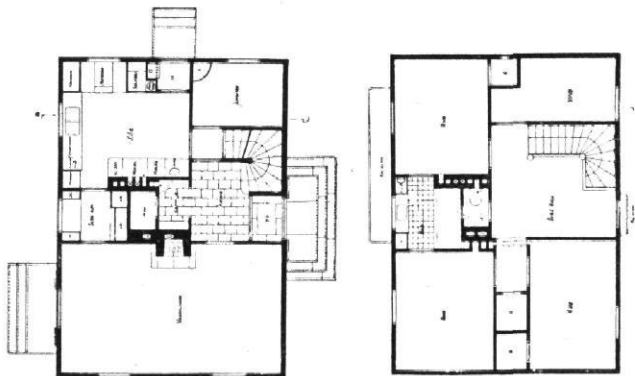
bis 22 | Einfamilienhaus auf der Lidingö-Ausstellung 1926 (vgl. Abb. 16) | Oben und rechts zwei Hauptansichten, links Aufrisse und Grundrisse 1:250
